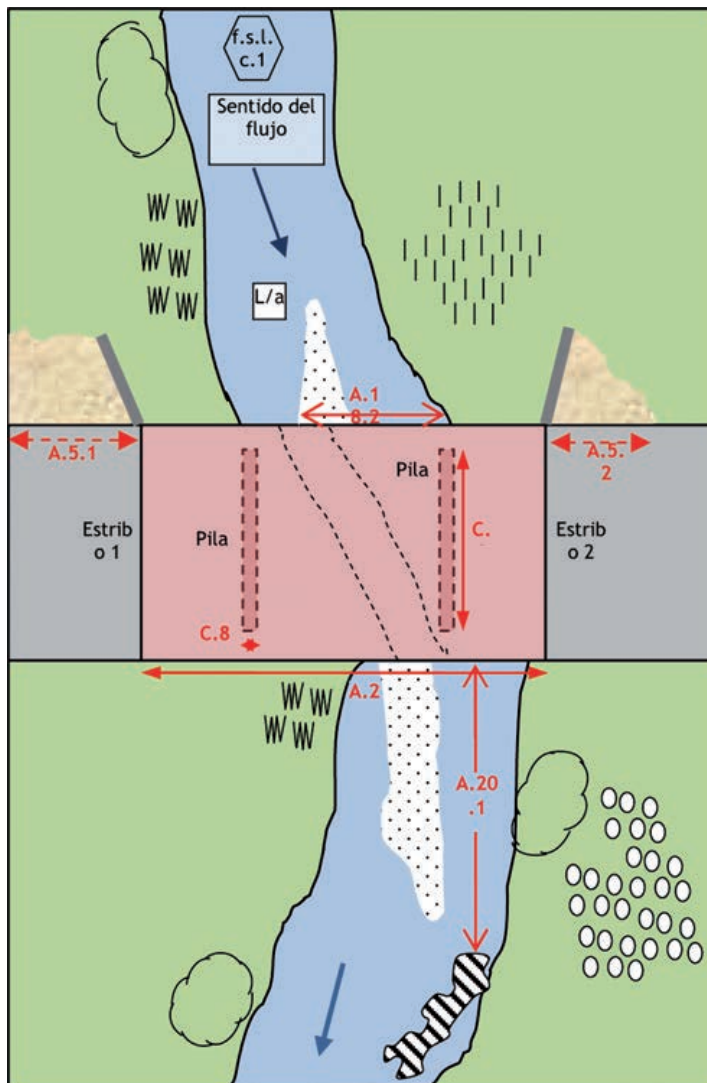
CROQUIS CON ALGUNAS DE LAS SIMBOLOGÍAS A UTILIZAR.
